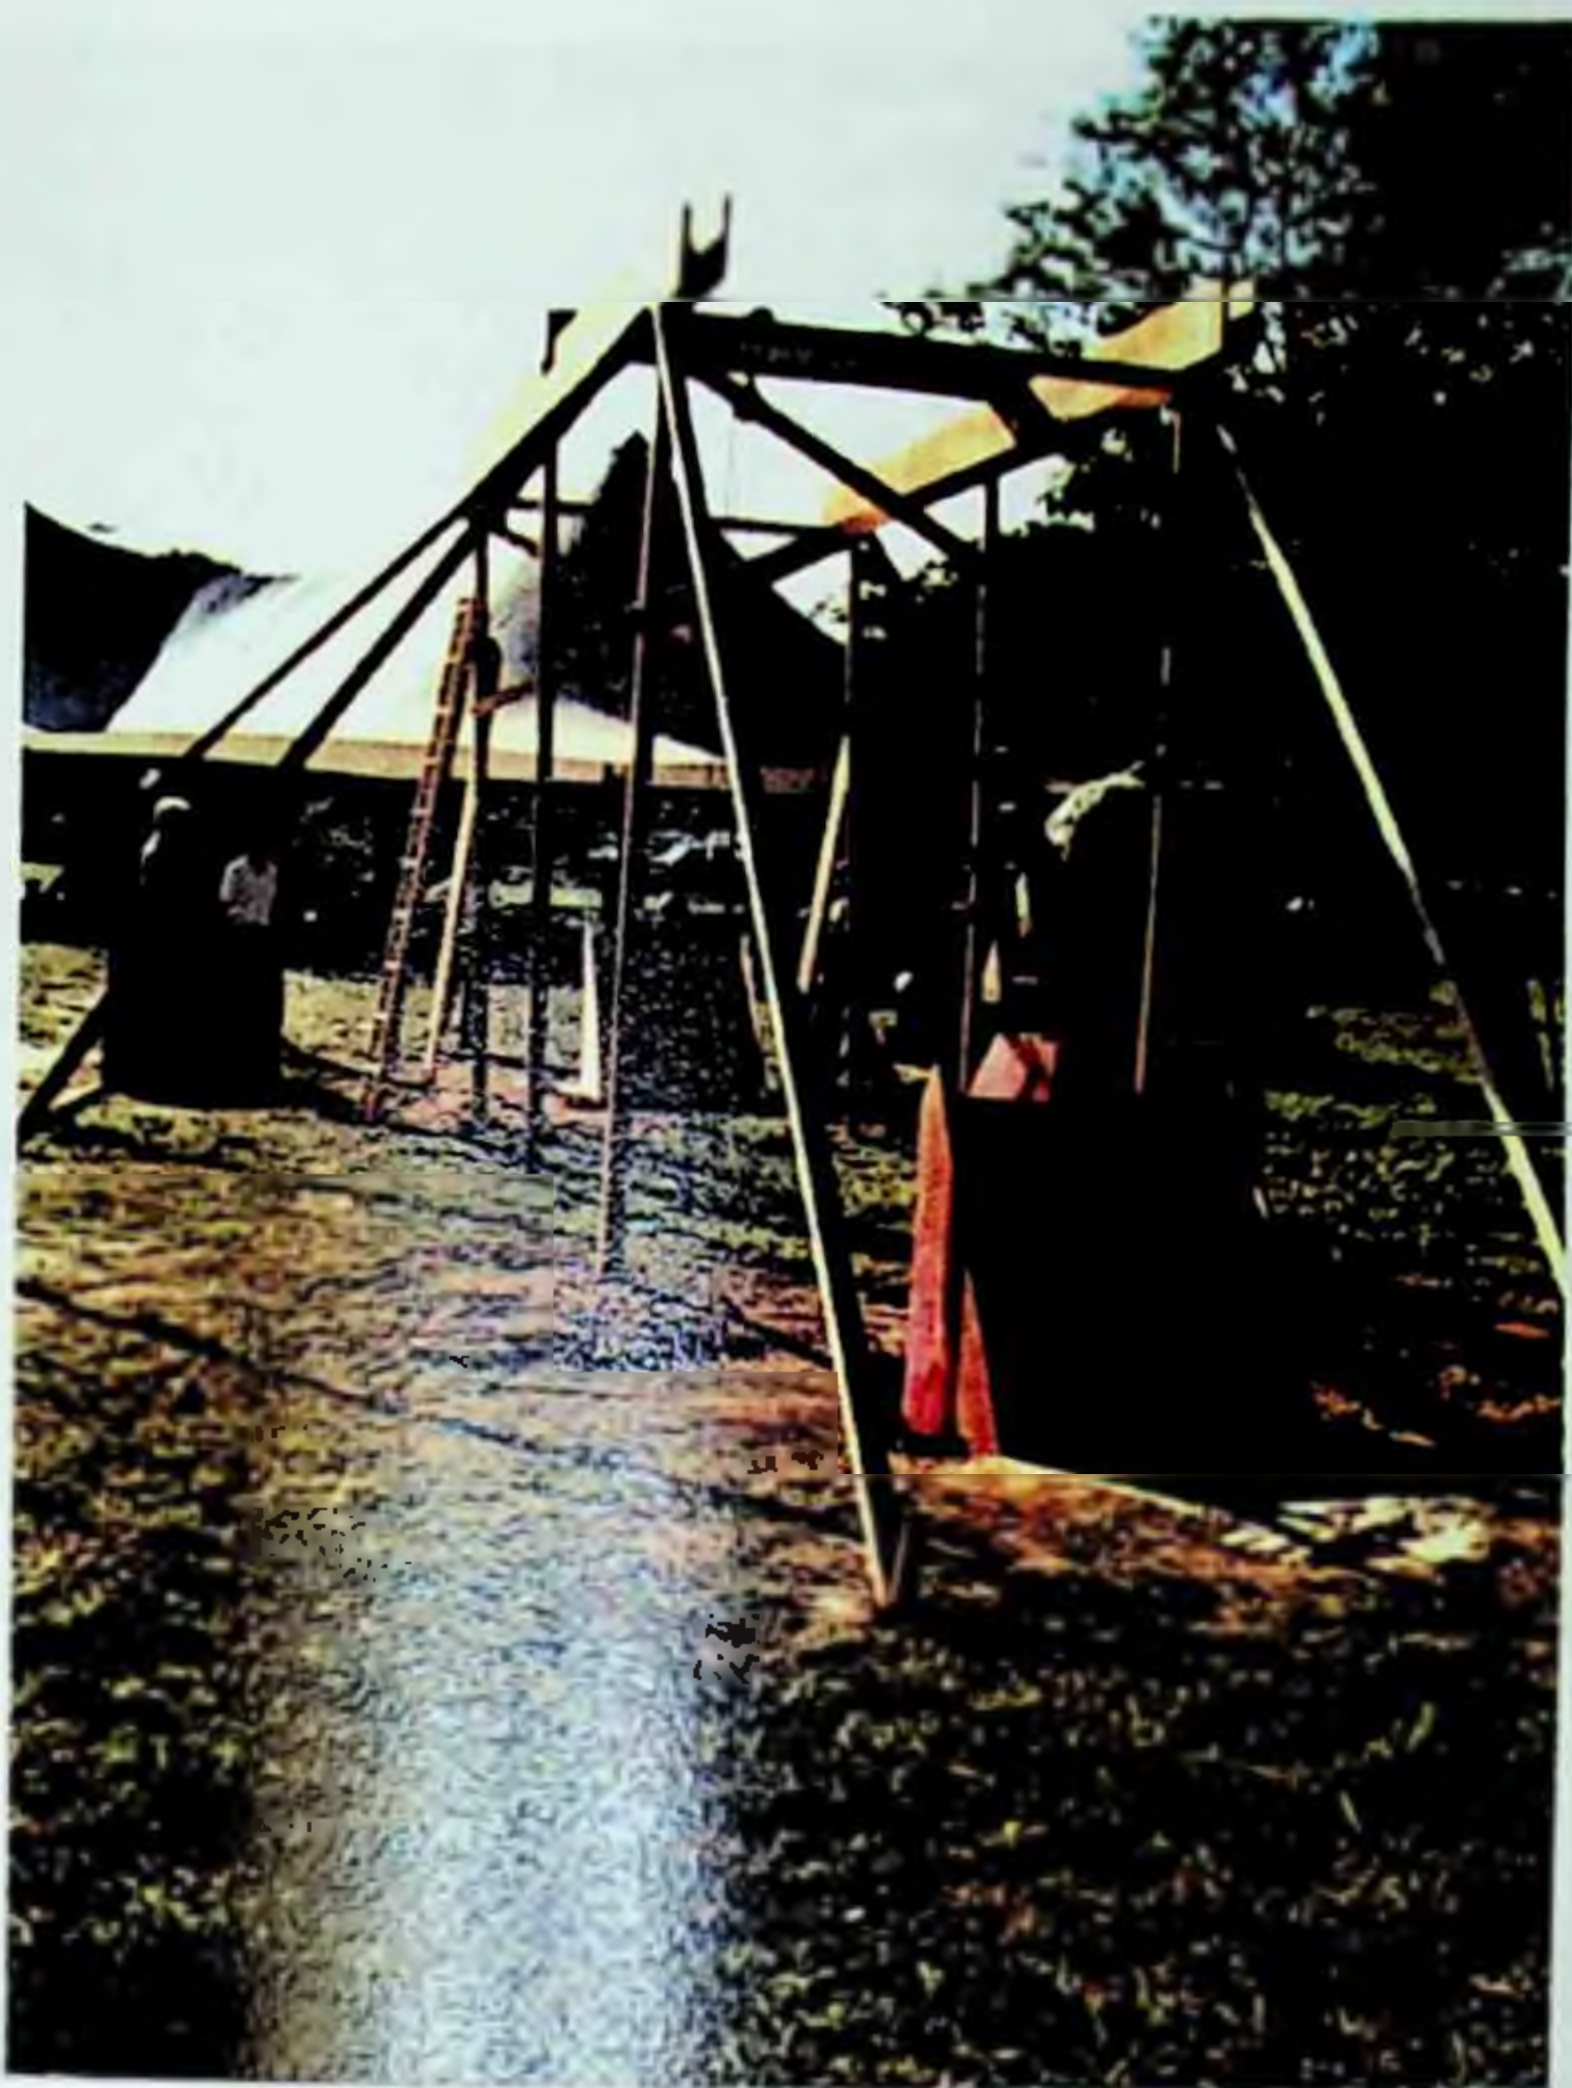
A "ponte rolante" construída nas oficinas e em pleno uso.
